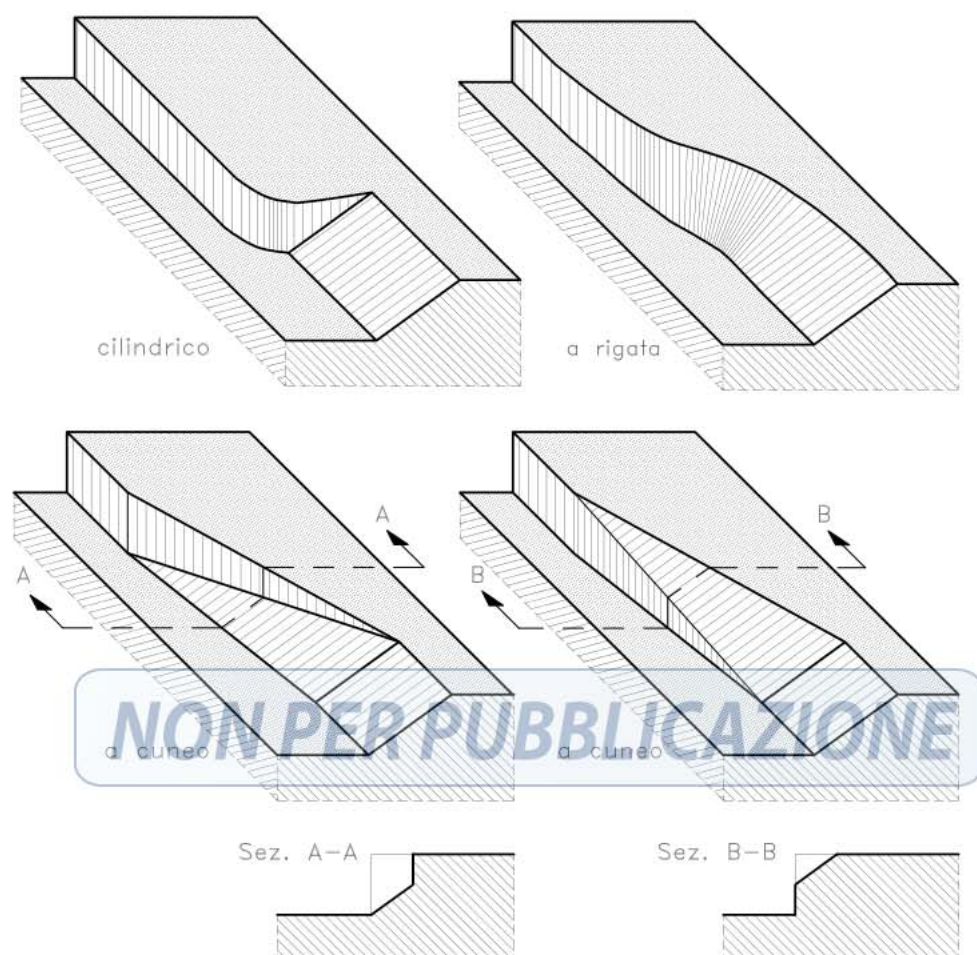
Esempi di raccordo di un canale da sezione rettangolare a sezione trapezia (da adottare in corrente lenta).
